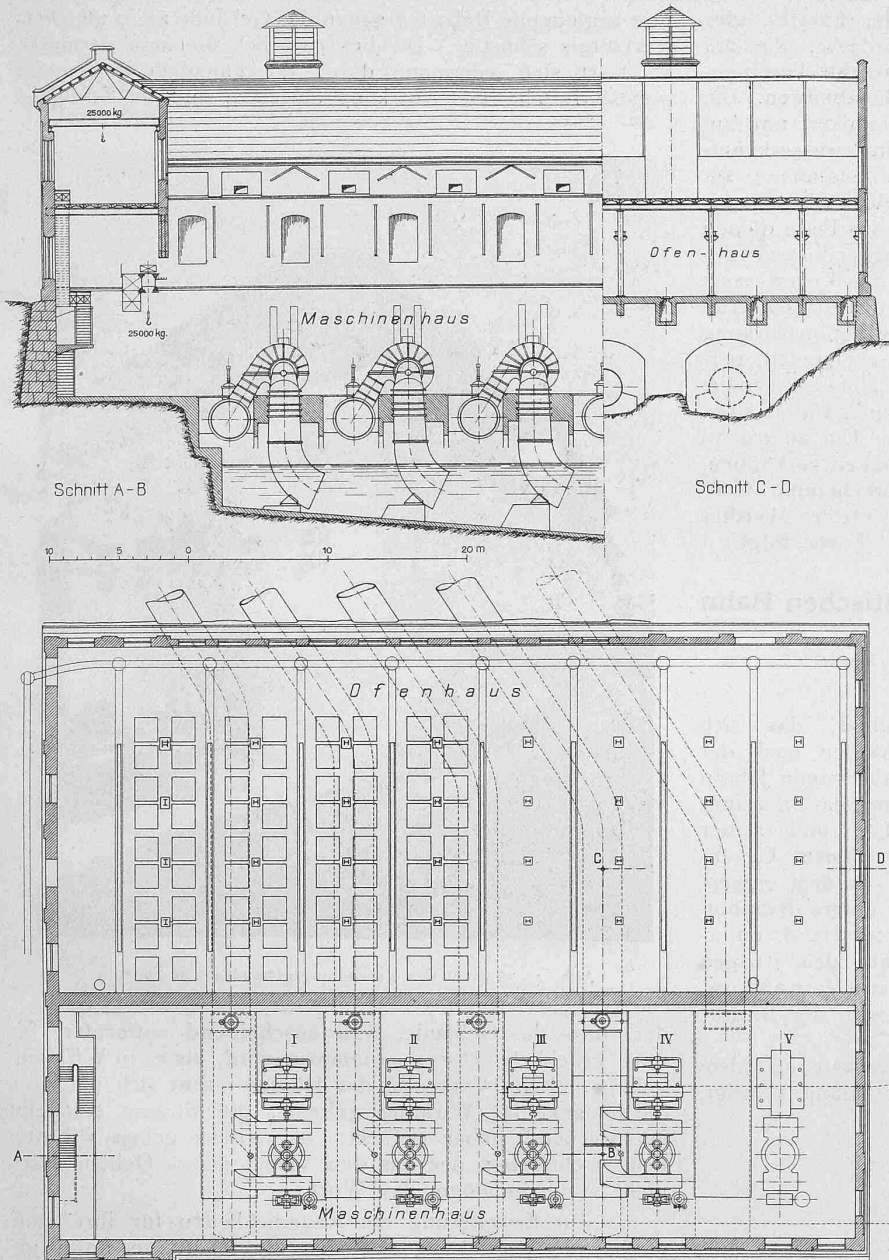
Grundriss; Abb. 13. Längsschnitt A-B, C-D des Maschinenhauses. — 1:500.
